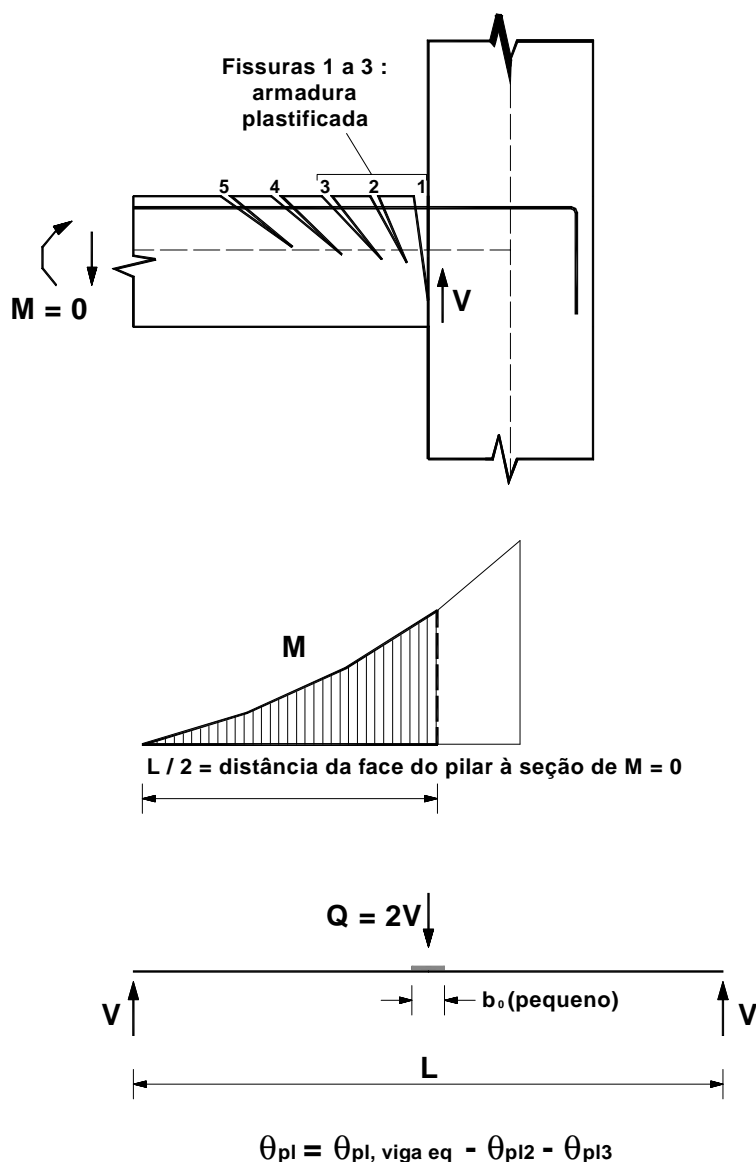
Capacidade de rotação plástica para o caso de pórtico plano. Exemplo com três fissuras plastificadas.
